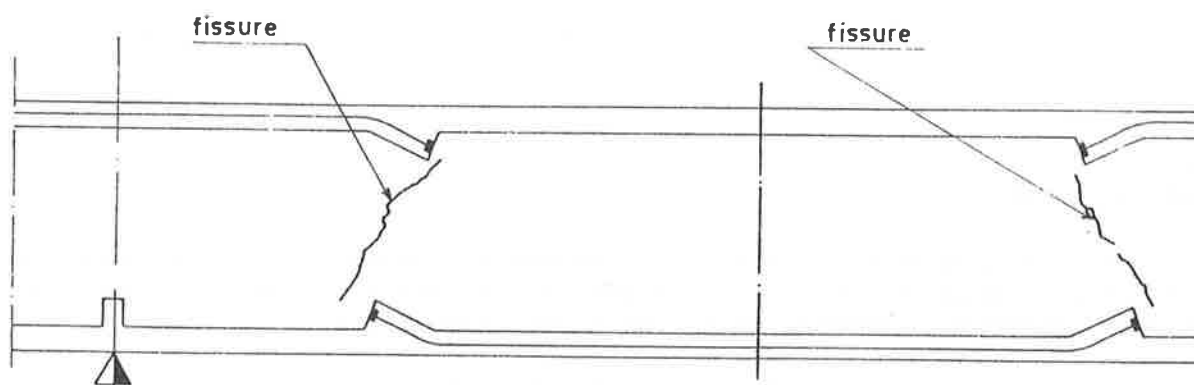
Fessurazione dell'anima di una travata a cassone in corrispondenza di ancoraggi intermedi
